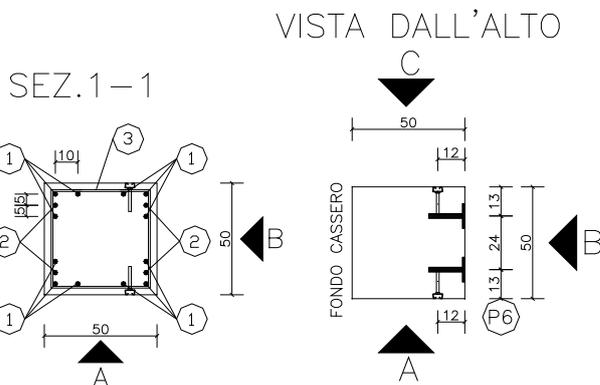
Esempio di pilastro monopiano (anno 2008)
